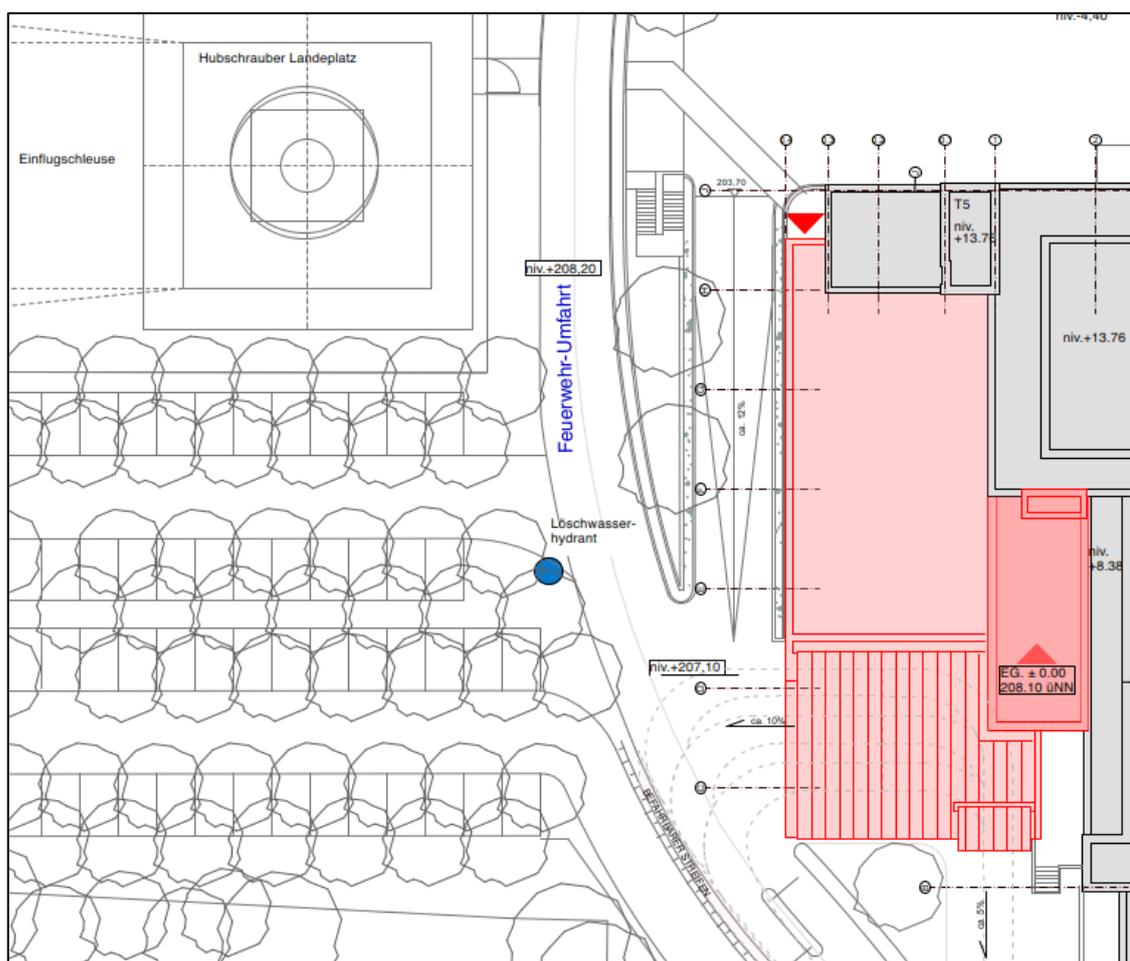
Extrait du plan d'implantation du projet d'extension des urgences
